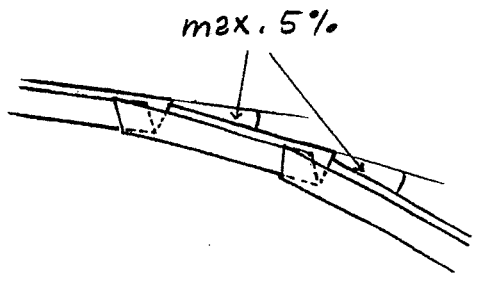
Bau eines Holzkännels mit V-Querschnitt
